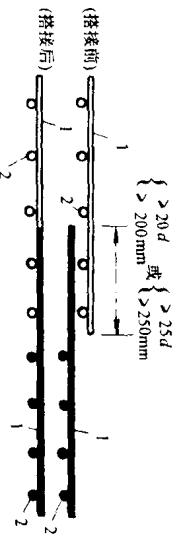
钢筋焊接网在非受力方向的搭接
